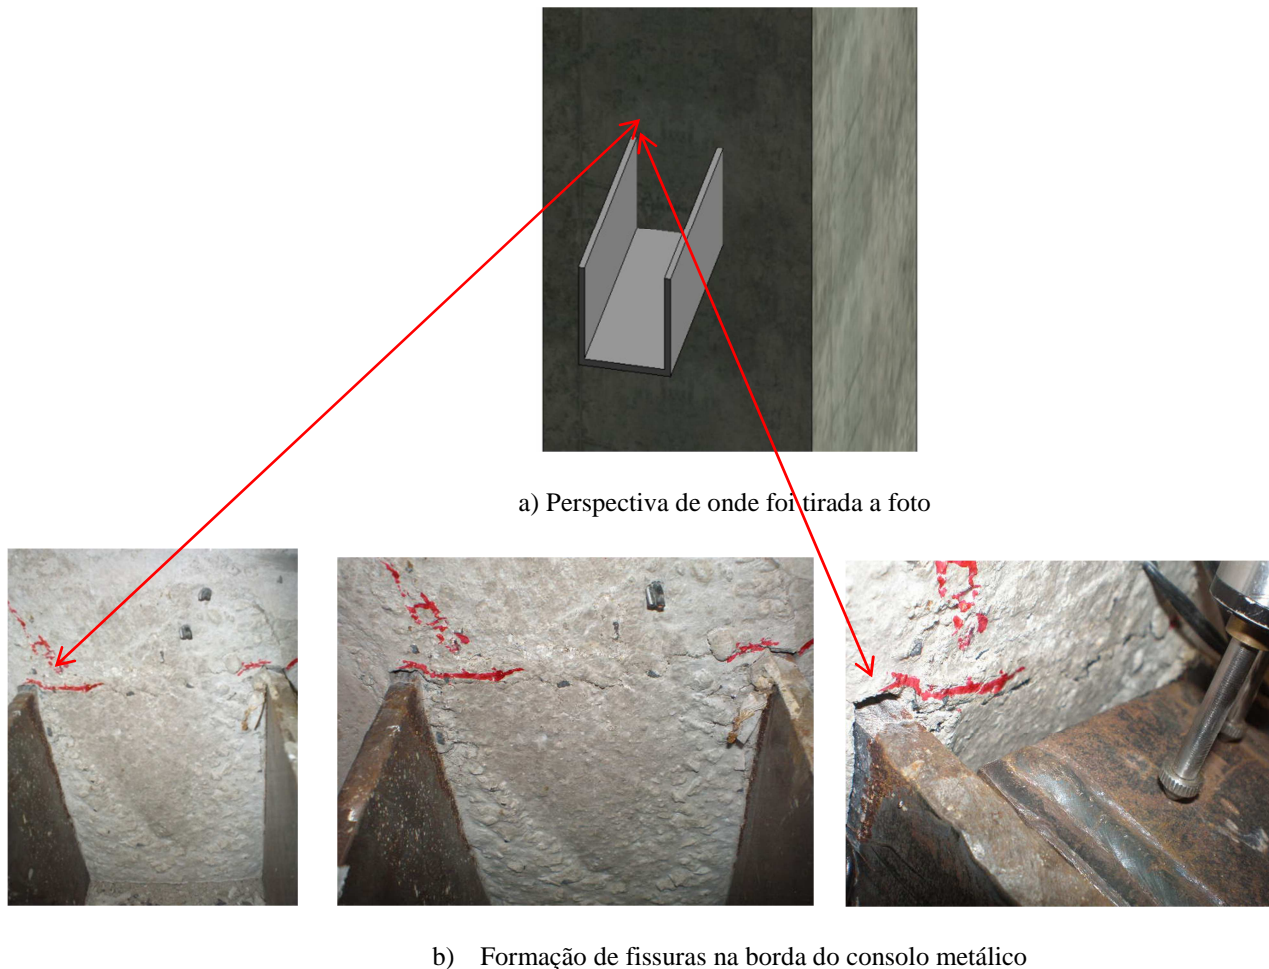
Marcação de fissuras junto a borda do consolo-7,5.
